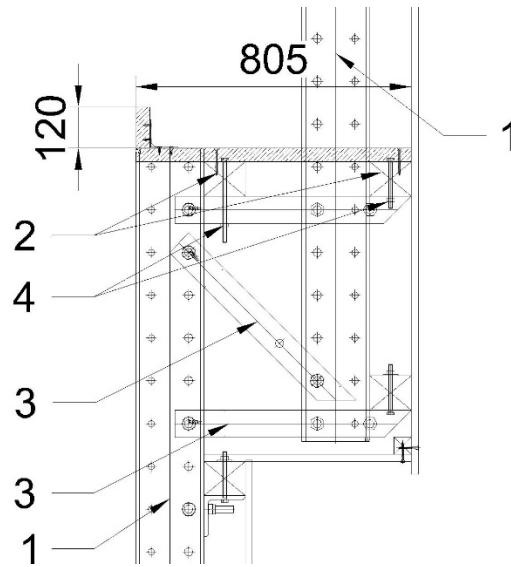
Схема влаштування робочої площадки, де 1 – штанга переставна; 2 – дерев'яний прогін (брус); 3 – балка поперечна 69 RCS; 4 – болт для фіксації прогону до балки поперечної
